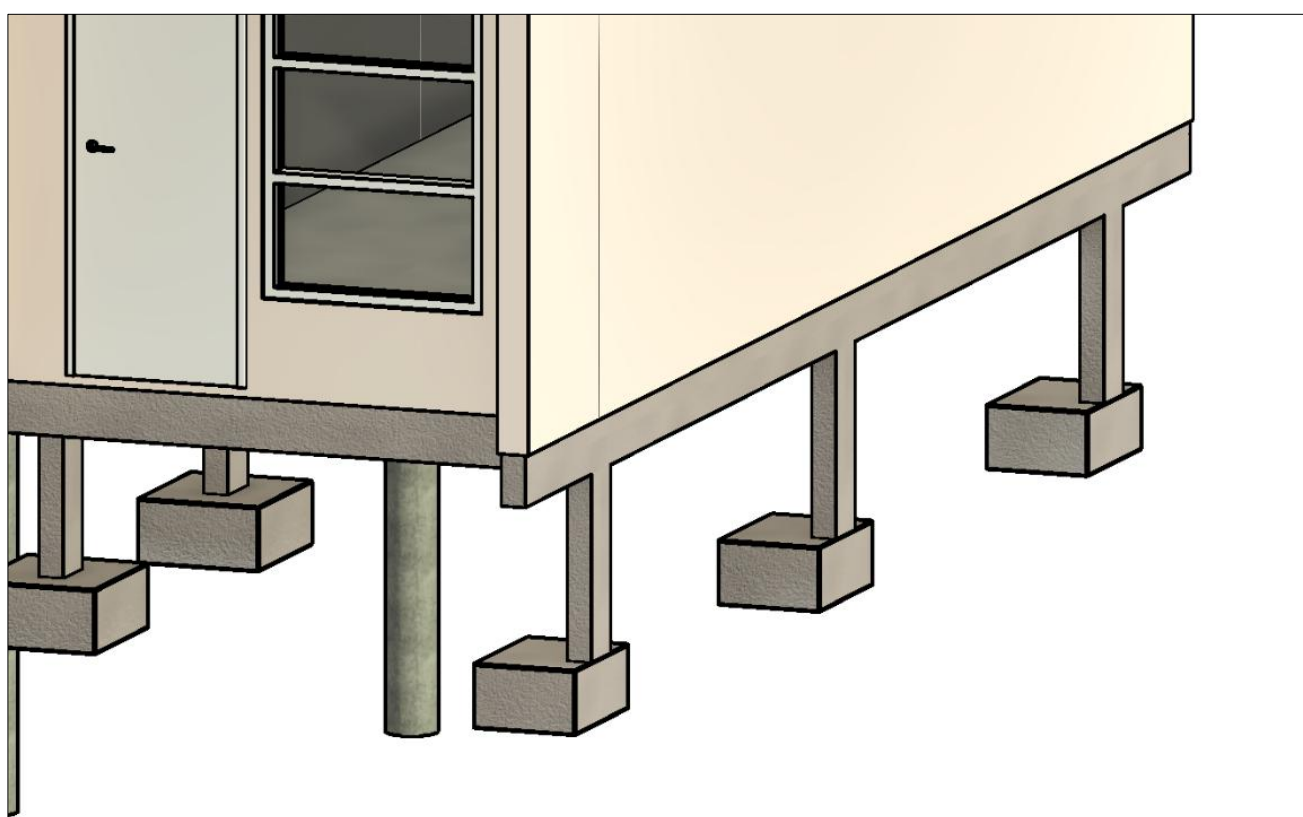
Omissão da viga baldrame sob o muro de divisa no Projeto Estrutural Modelado.
